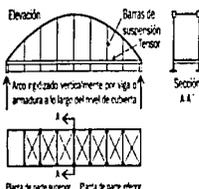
Membradura de arco rigidizada horizontalmente mediante refuerzo.
